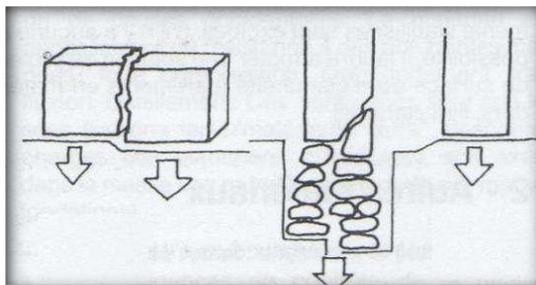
Tassement différentiel engendrant la déstabilisation de la fondation.
